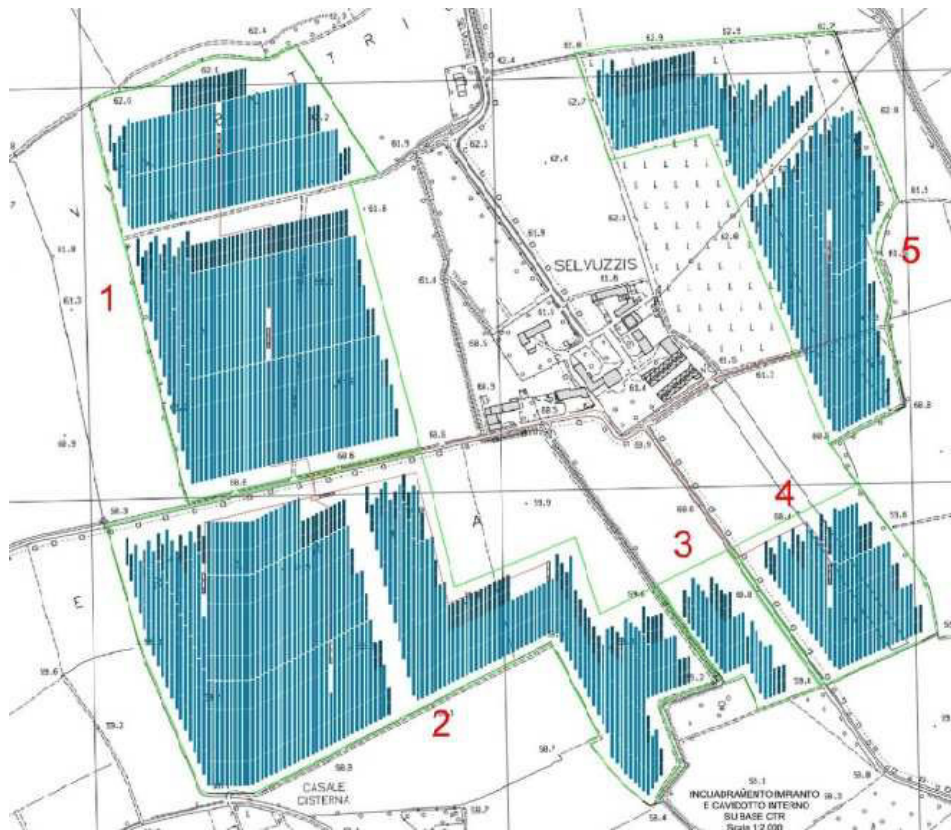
Individuazione delle aree interessate dall’impianto in progetto su base CTRN
